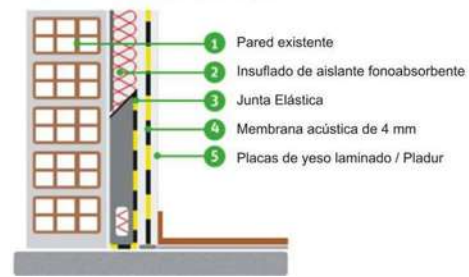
Aislamiento acústico de pared. Fuente: Manuj, Reforma Coruña.
